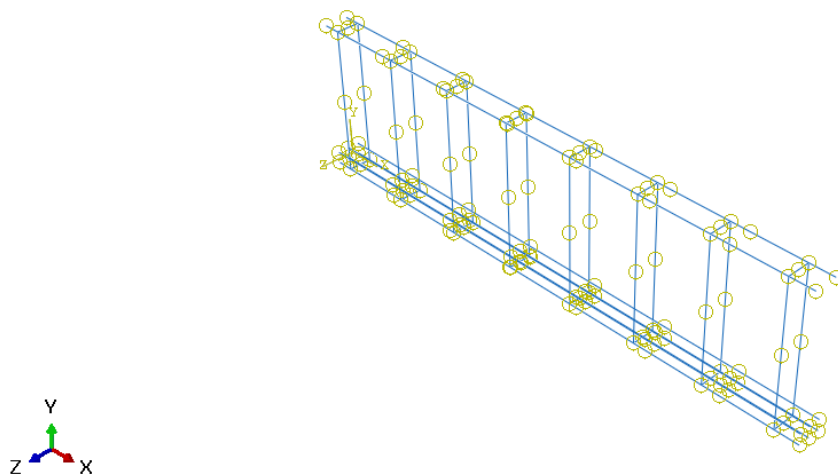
Condición de interacción armadura – viga aplicada a la armadura.
